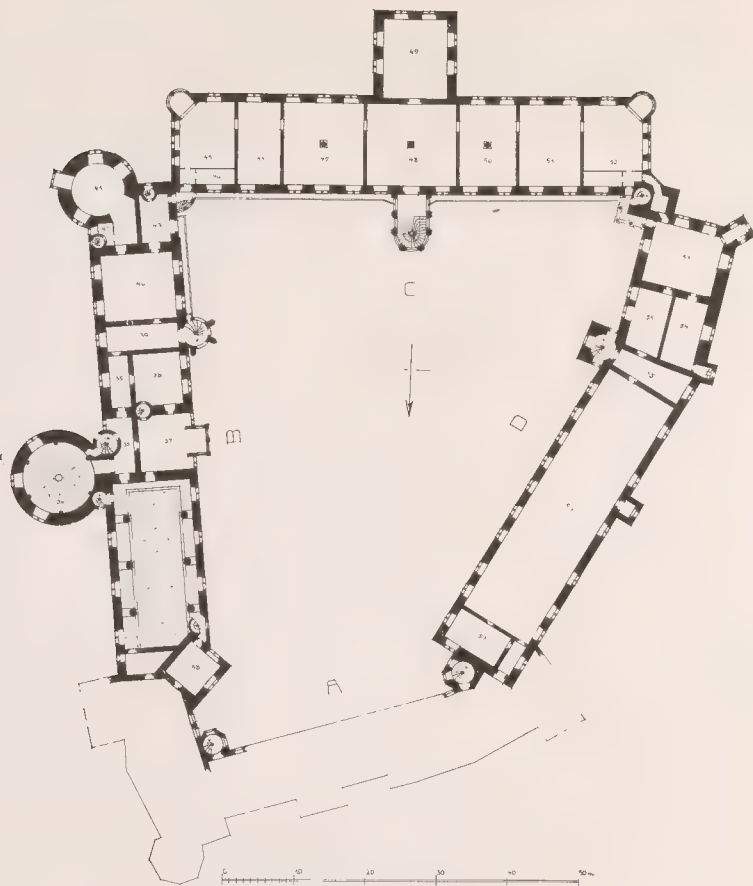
Rekonstruierter Grundriß des zweiten Obergeschosses.
